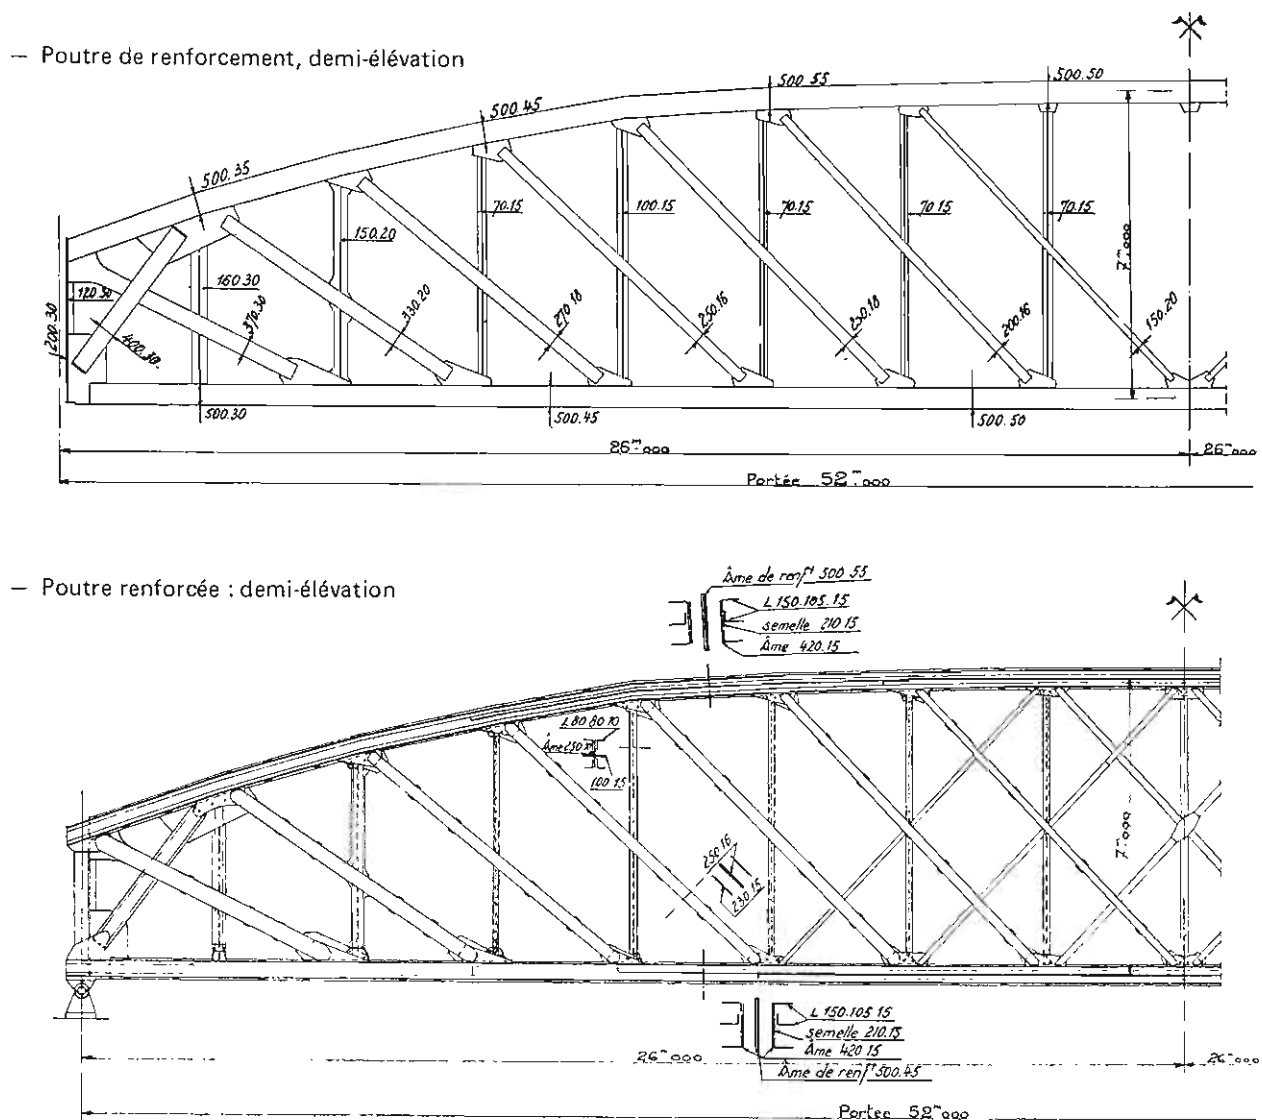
Pont sur l'Ill – Principe de renforcement.
